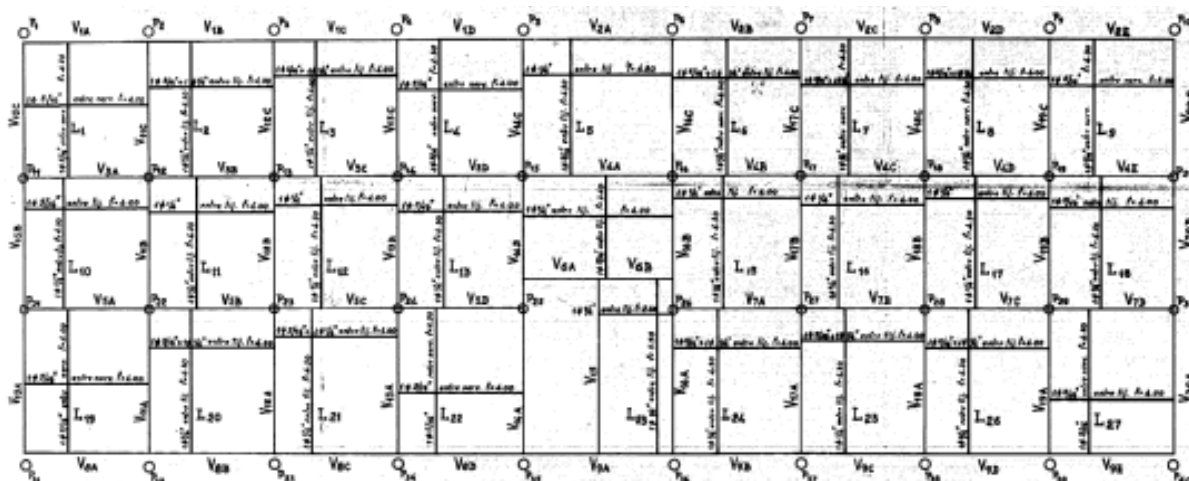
Planta de estrutura do tecto da cave do bloco de Costa Cabral
